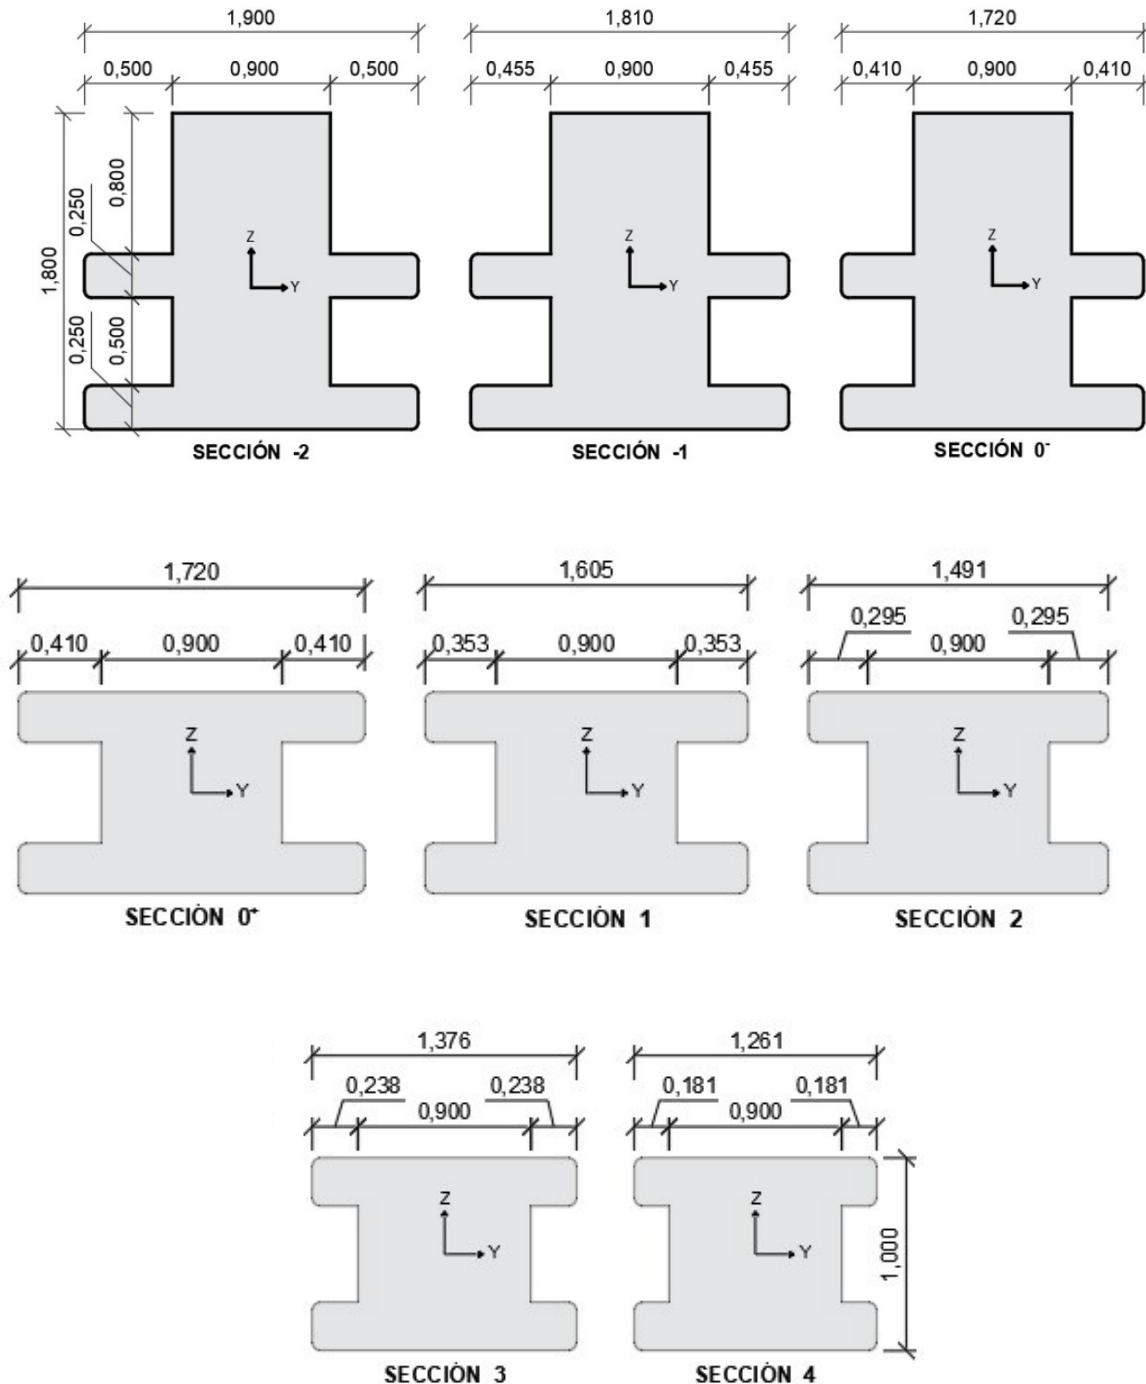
Secciones transversales del pilono. (Fuente: elaboración propia)
